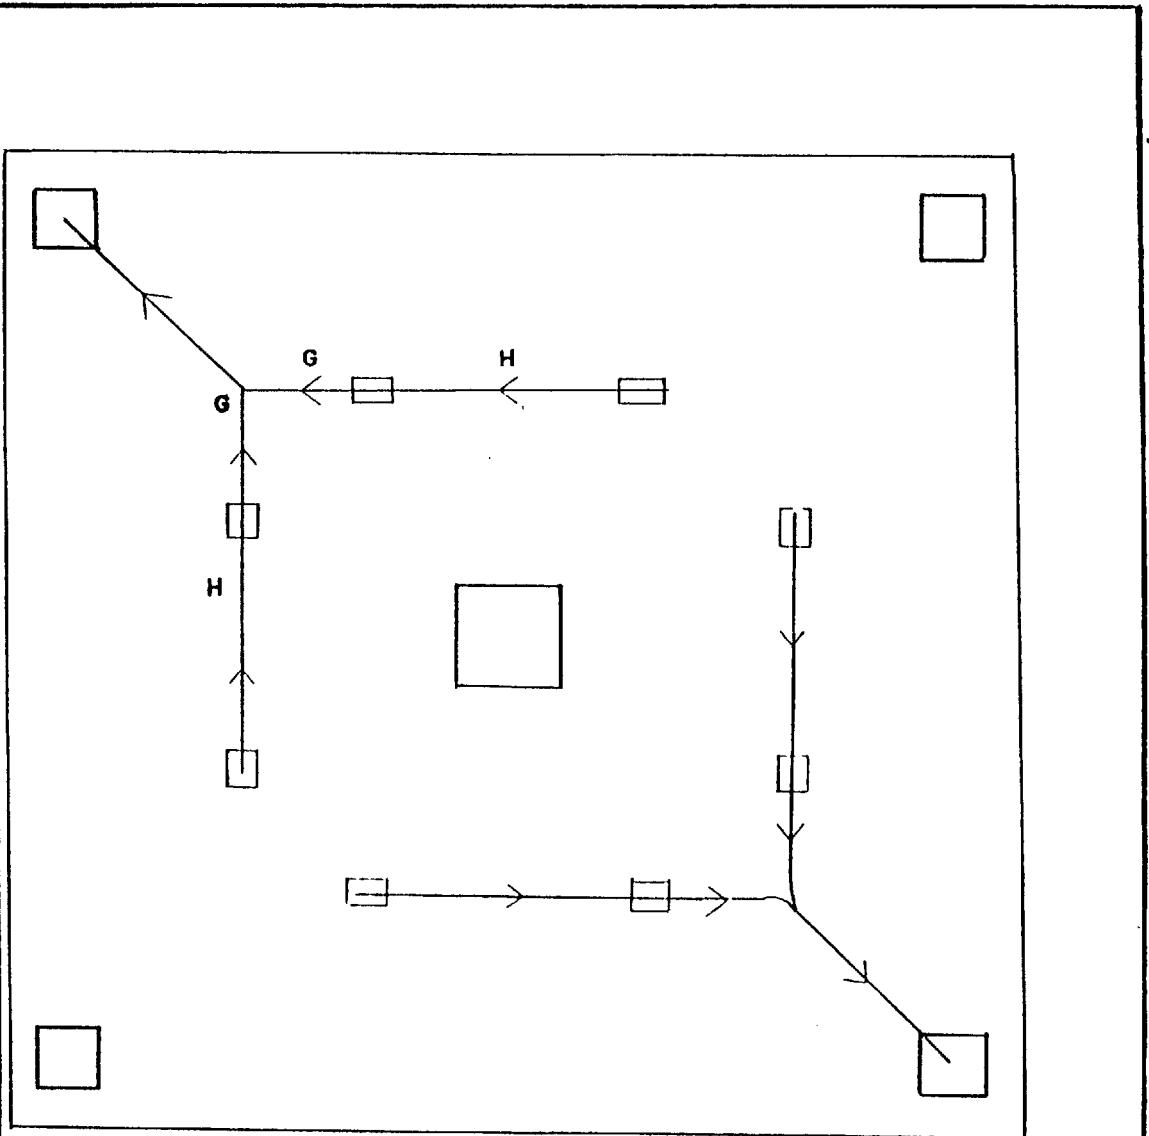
\_ ESQUEMA DEL SISTEMA DE DUCTOS DE EXTRACCION ( EN PLANTA )
